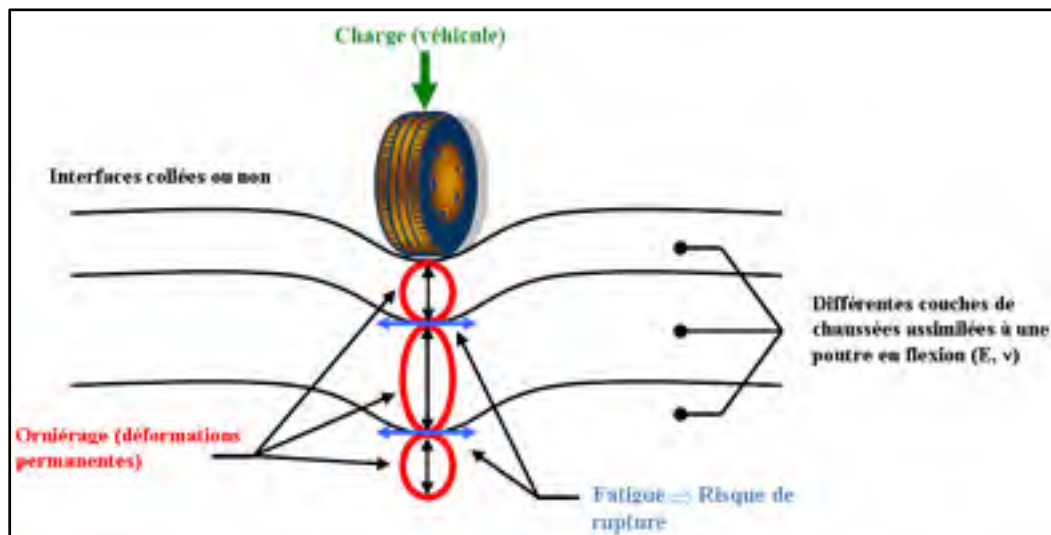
Les sollicitations induites par le trafic sur une chaussée bitumineuse adaptée de (Di Benedetto & Corté, 2005)
